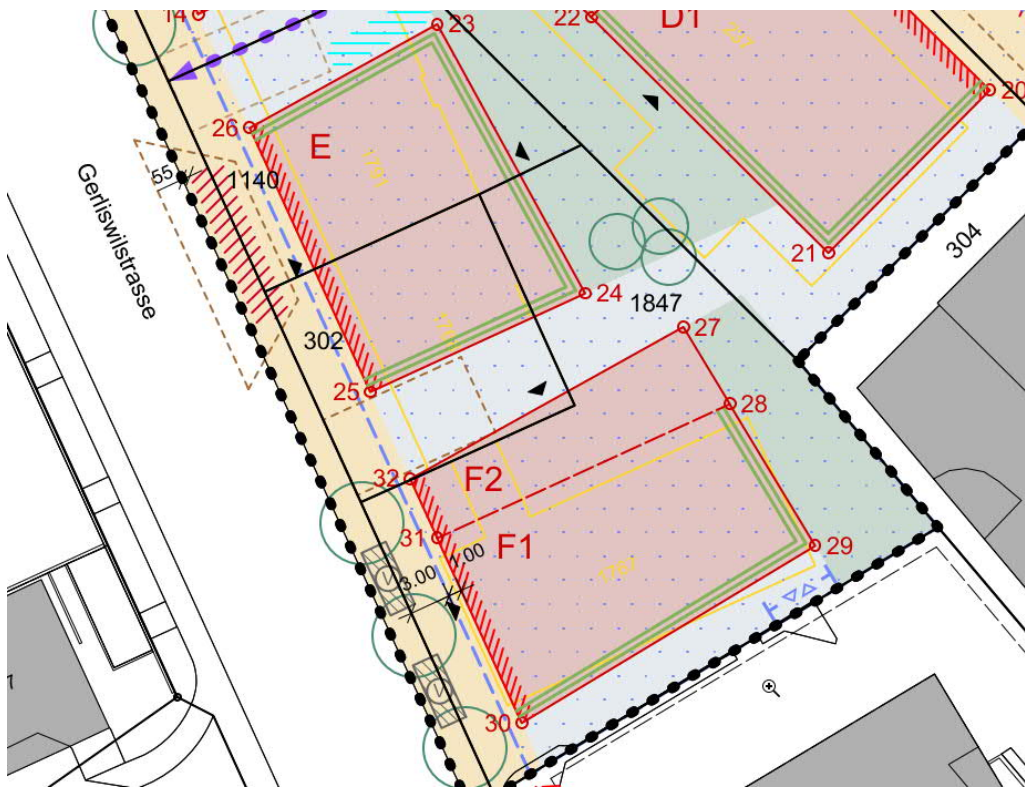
Ausschnitt Situationsplan Bebauungsplan nach Anpassungen
